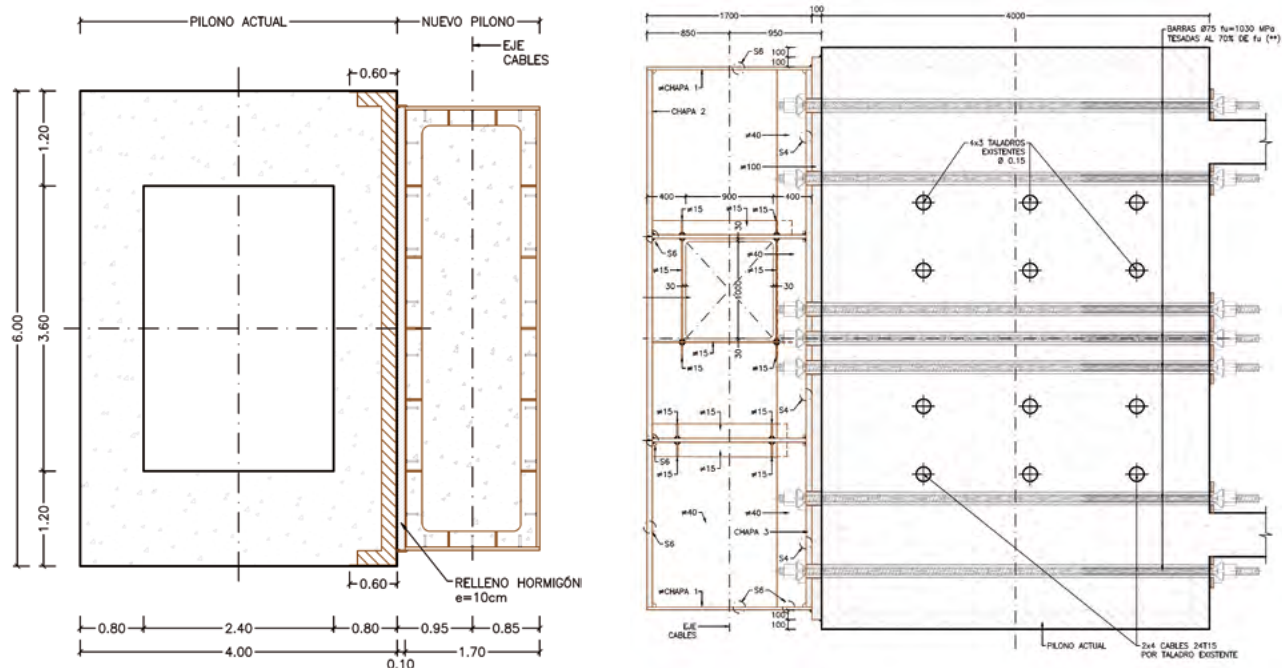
Sección transversal del pilono recrecido en el lateral exterior mediante una estructura mixta y detalle de conexión del cajón metálico al pilono mediante barras de pretensado.
